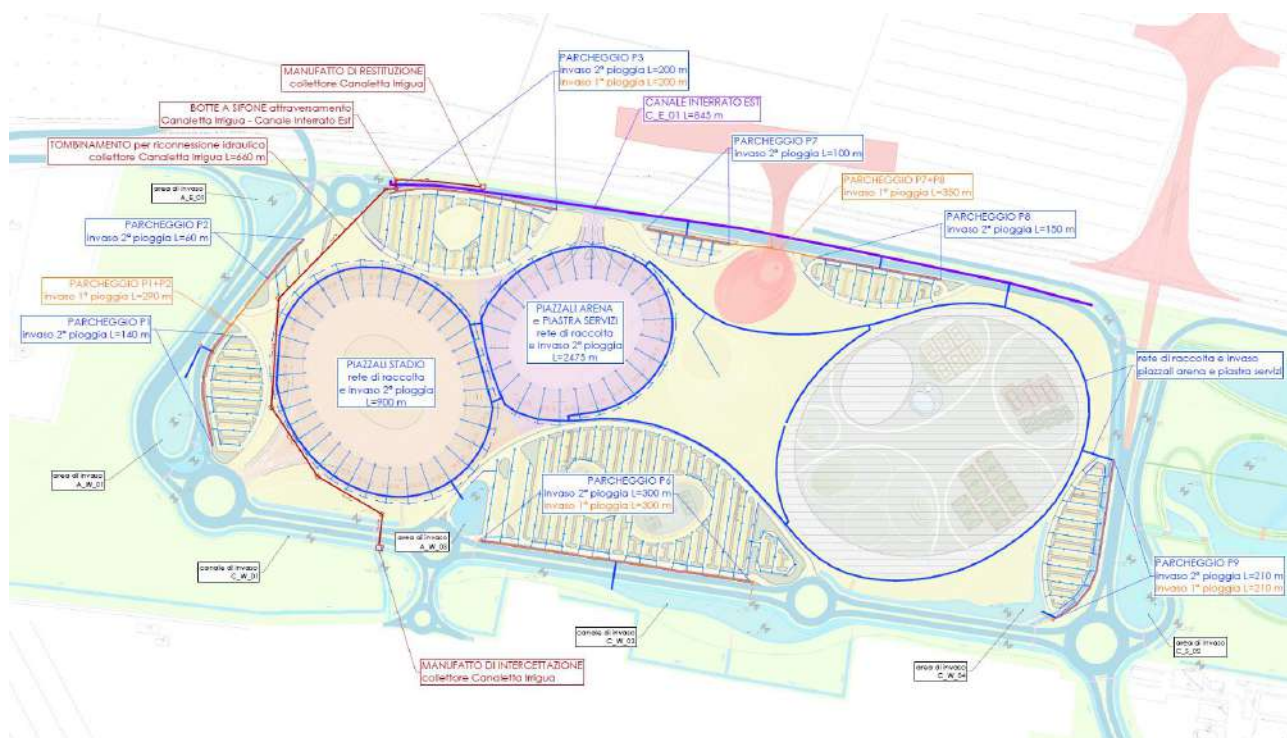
Opere di compensazione - Planimetria degli invasi profondi
